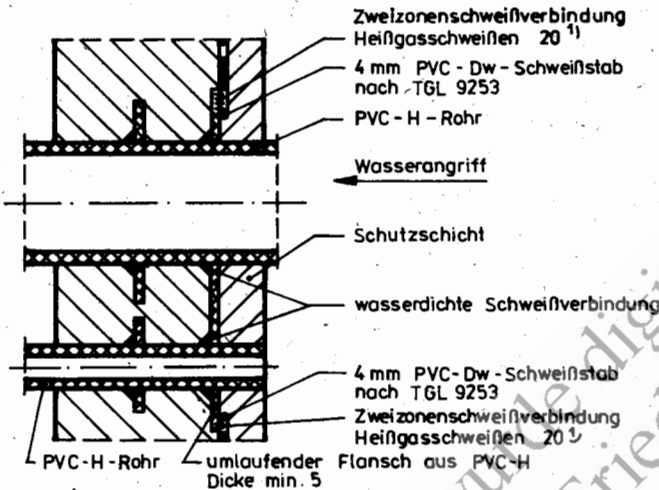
Durchführungen mehrerer Plaströhre über einen gemeinsamen Festflansch aus PVC-H, Dichtung auf Festflansch geschweißt
